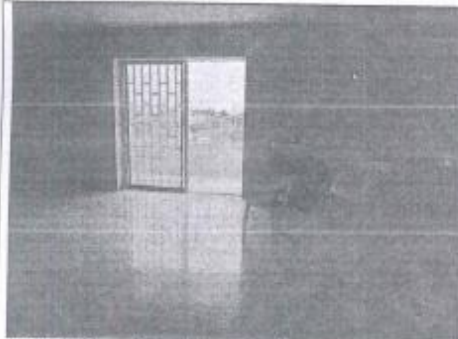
Se observa el tercer piso de la construcción, donde se encuentra un apartamento.
